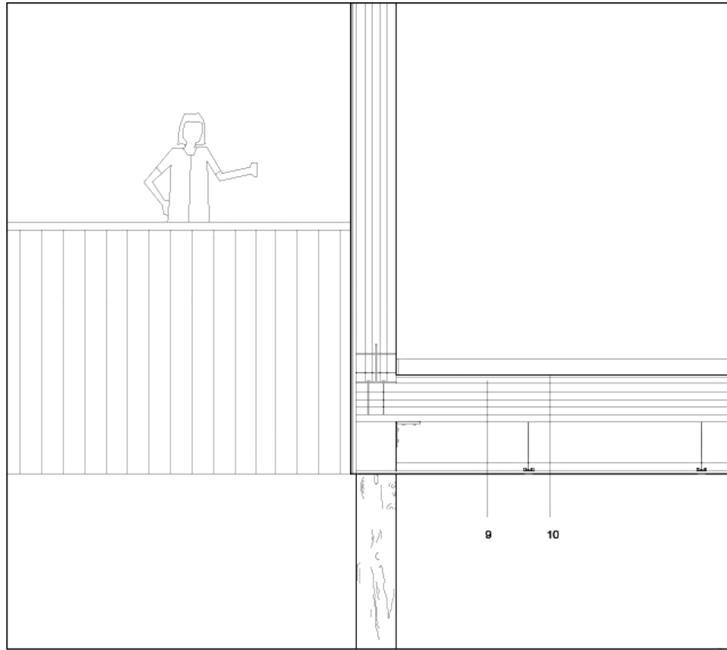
; Pormenor P4 da figura 4.23. 9 Argamassa de nivelção, 40mm; 10 – Acabamento do pavimento em linóleo cinzento, 10mm.
